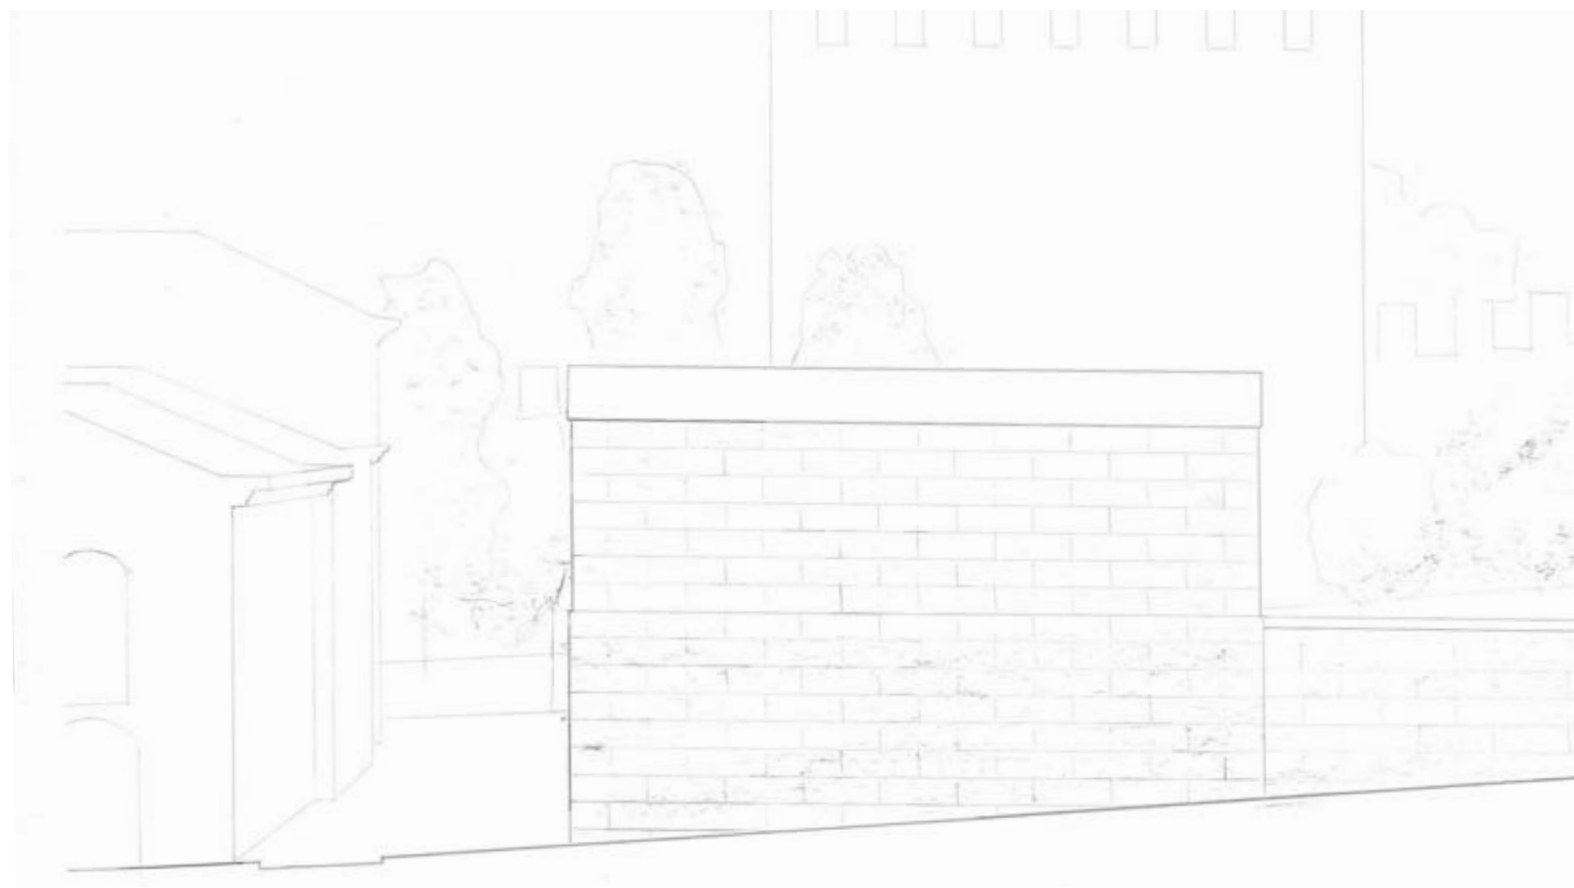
Realizado posteriormente aos painéis – Alçado poente, escala 1:100.
